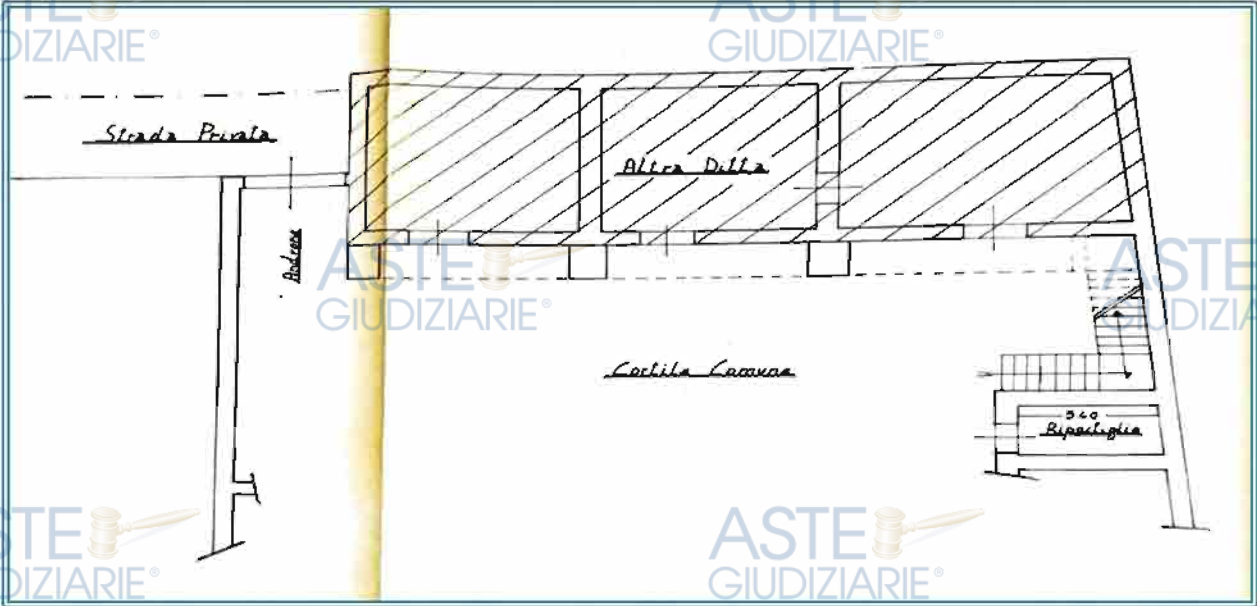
Pianta piano terra – estratto dal fascicolo pratica di costruzione edile n. 5951 del 17.03.1988
